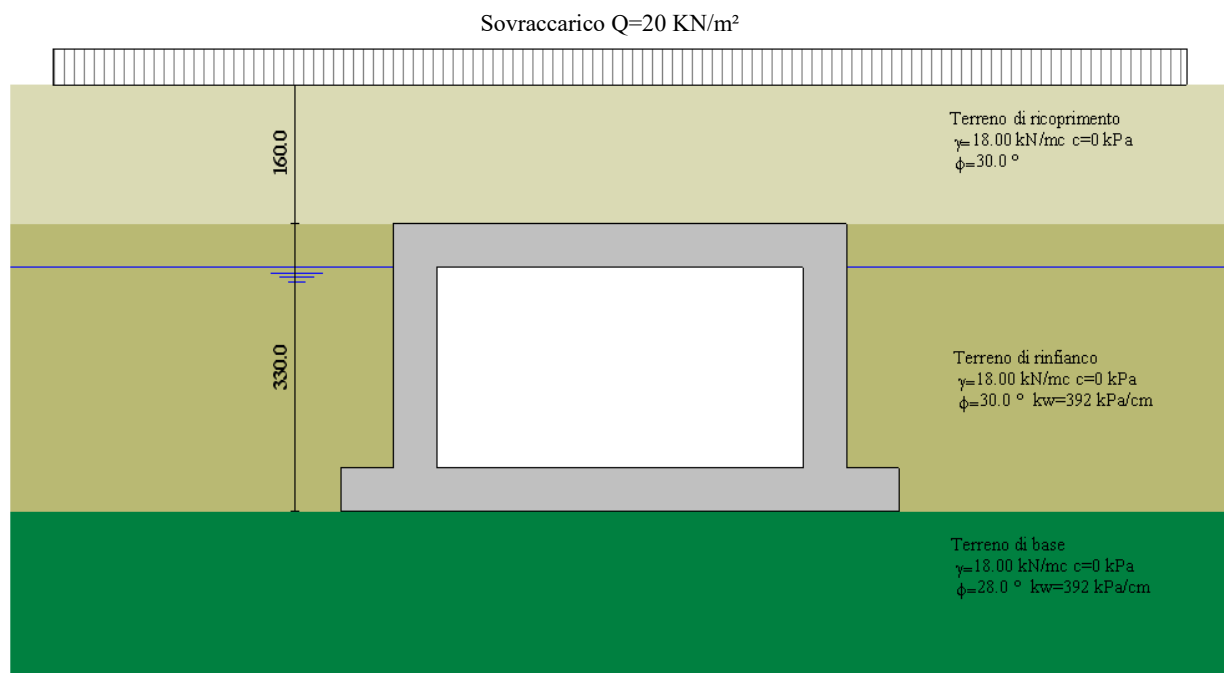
Modello geotecnico e strutturale, sezione tipo del canale di adduzione
